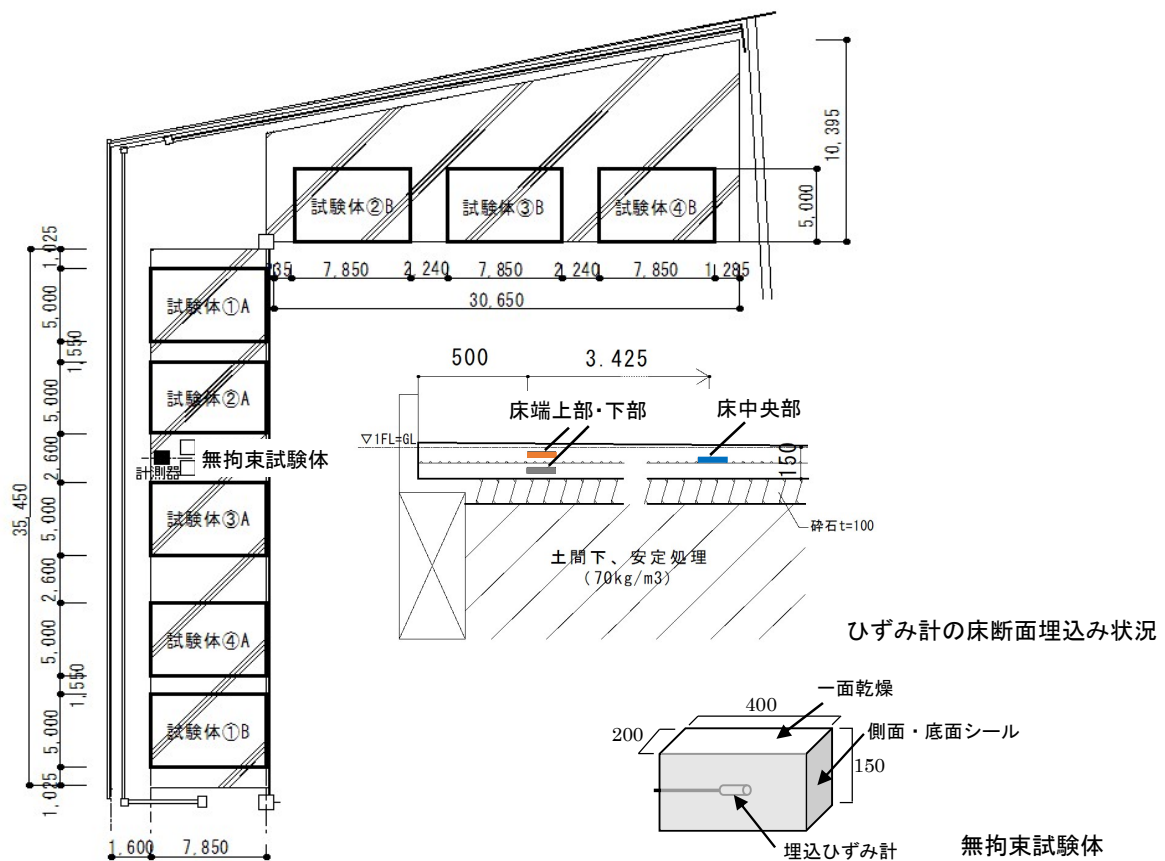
土間床の配置図, ひずみ計の床断面埋込み状況, 無拘束試験体
